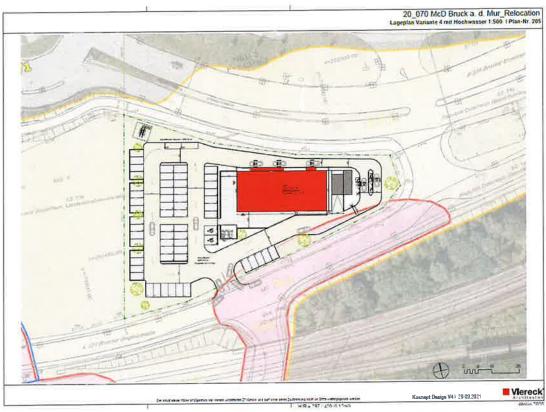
Lageplan Projekt (Quelle: Vierkant Architekten, 29.03.2021)
